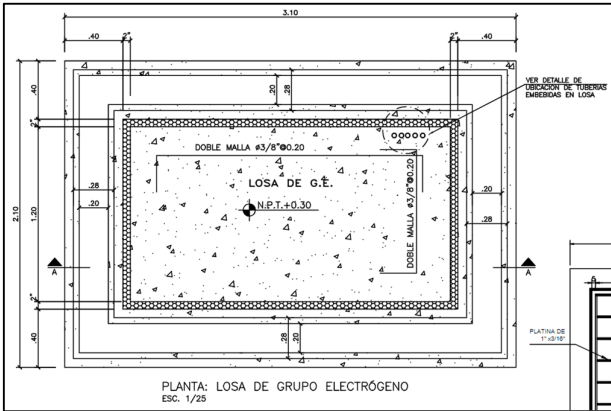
Plano de Losa Maciza de Grupo Electrónico
